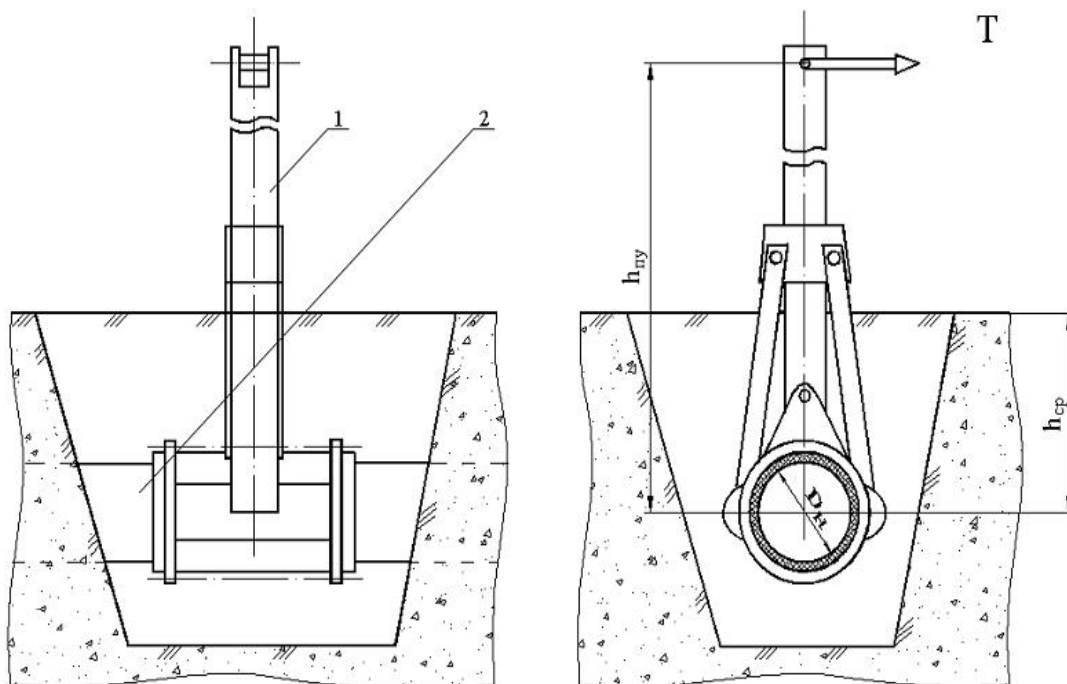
Схема передачи крутящего момента на подземный трубопровод:
